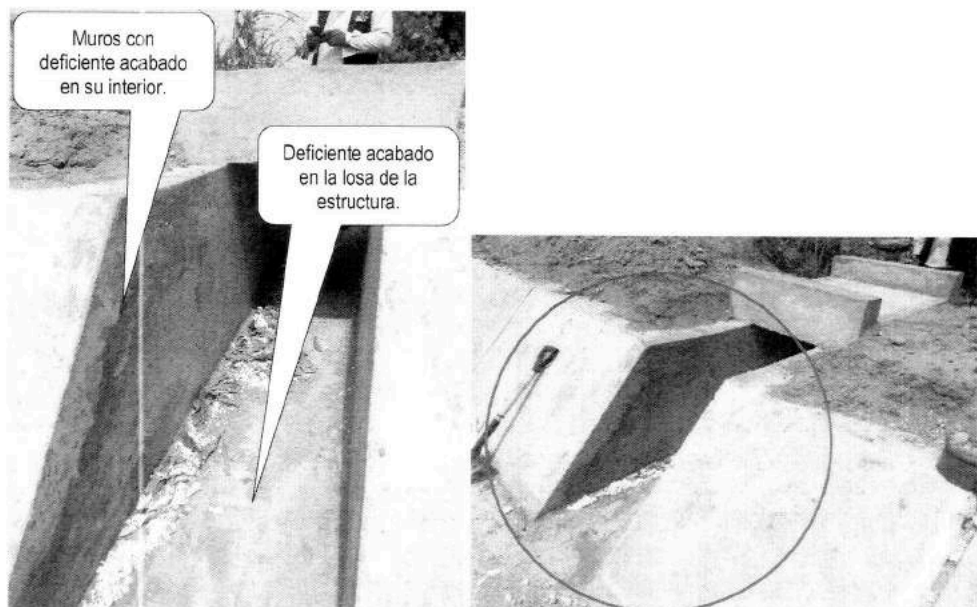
Construcción de Toma Predial Km 0+061 en el canal Clake, apreciándose deficiente acabado en los muros interiores, así como en la losa de la estructura. De igual manera se observa que no existen juntas entre la obra de arte y la caja del canal de riego.
